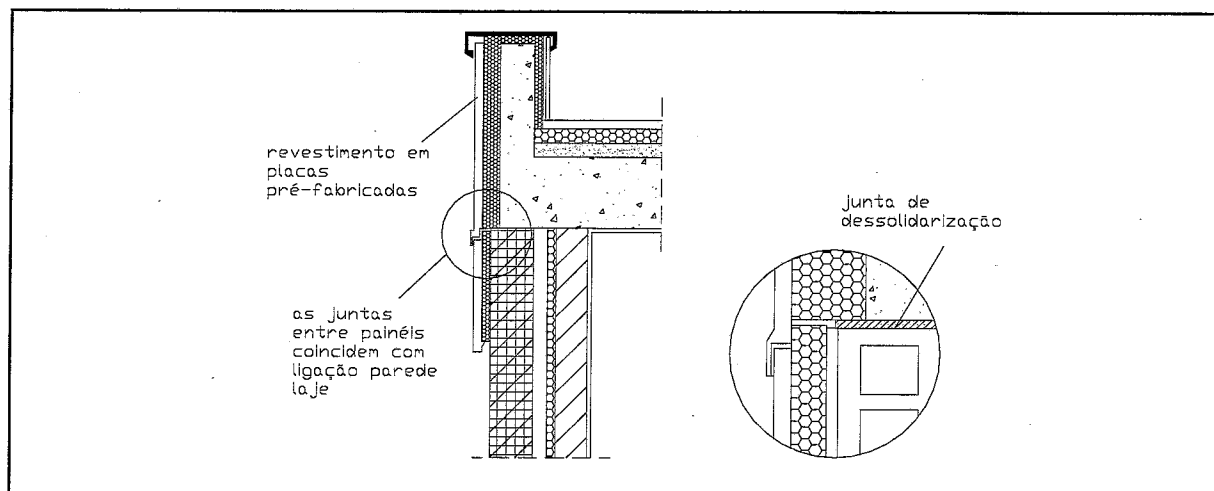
Pormenor de reabilitação térmica e reabilitação construtiva de zona de piso intermédio e laje de cobertura
